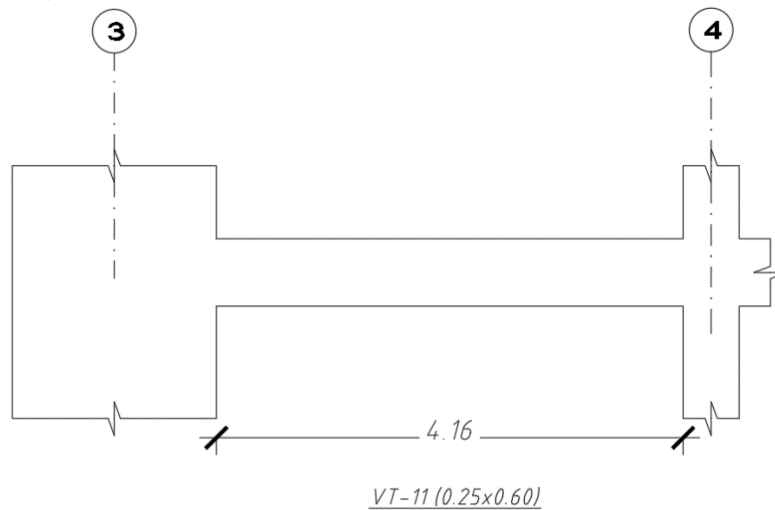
Elevación de viga del eje 3 (Piso 6)
